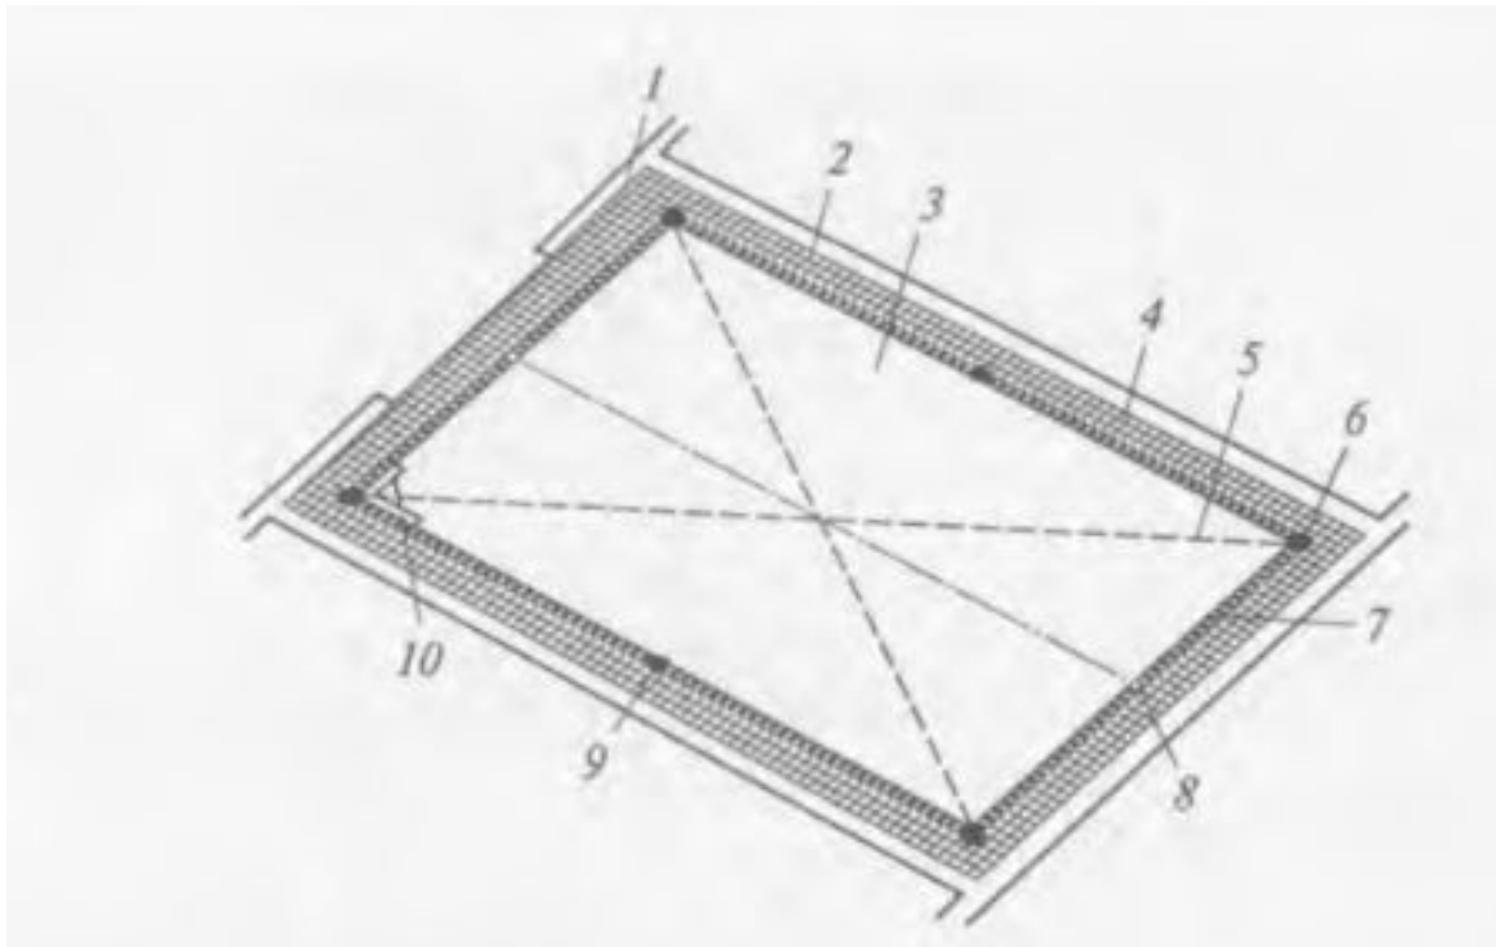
Разбивка покрытия пола и расположения маяков: 1— прирубленные плитки; 2 —заделка; 3— фон пола; 4, б, 9— реперный, фризový и промежуточный маяки; 5 — натянутый причальный шнур; 7 — фризový ряд; 8— стальной штырь; 10— угольник для разметки
